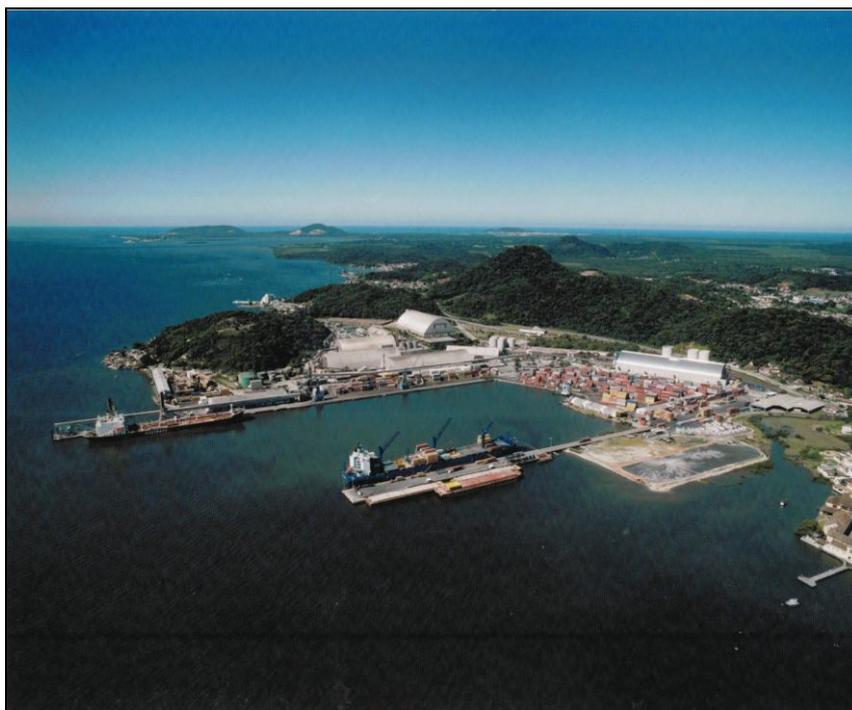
Porto de São Francisco do Sul, vendo-se ao centro o Berço 301 e a estrutura da TESC em fase de preparação do terreno (aterro). (Foto cedida por Ambient).
